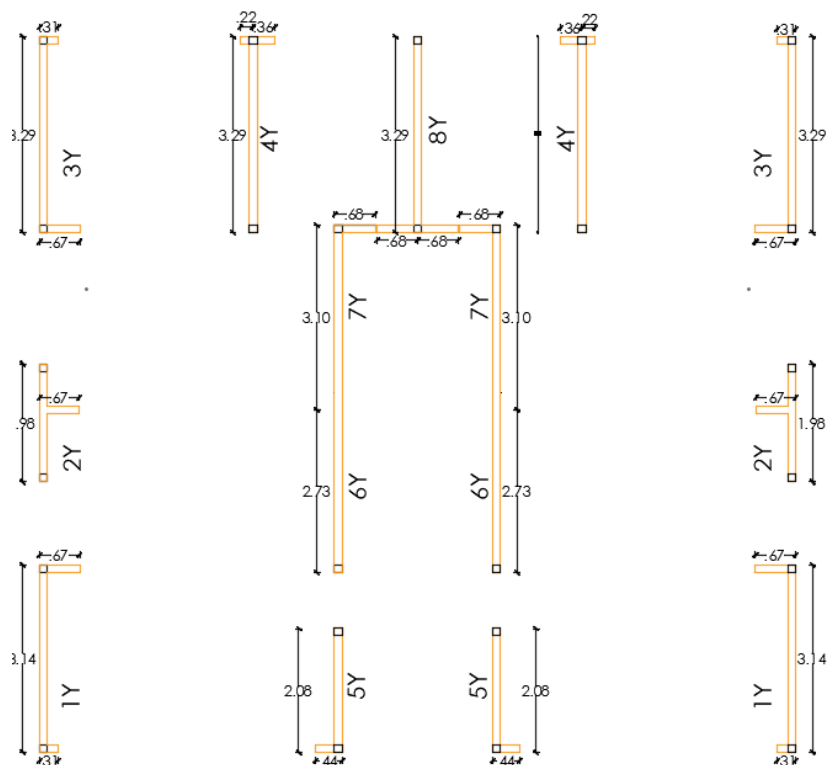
Aporte de rigidez de muros transversales en Dirección "Y" (Fuente: Elaboración propia).
